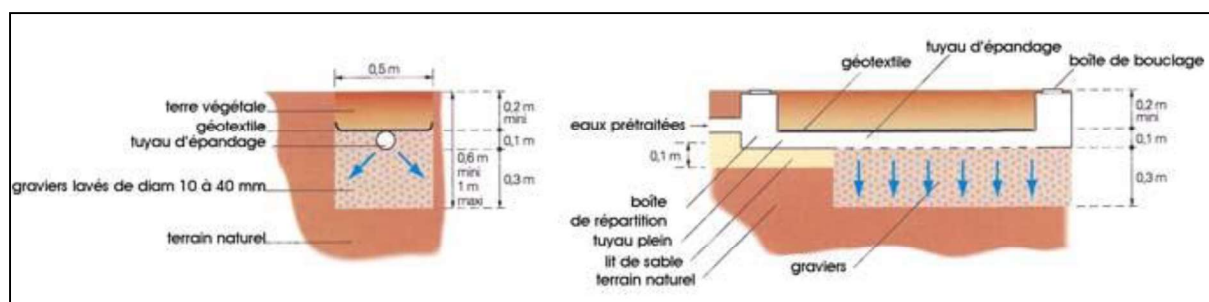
Schéma d'une tranchée d'infiltration (Source : Landrur.fr)
